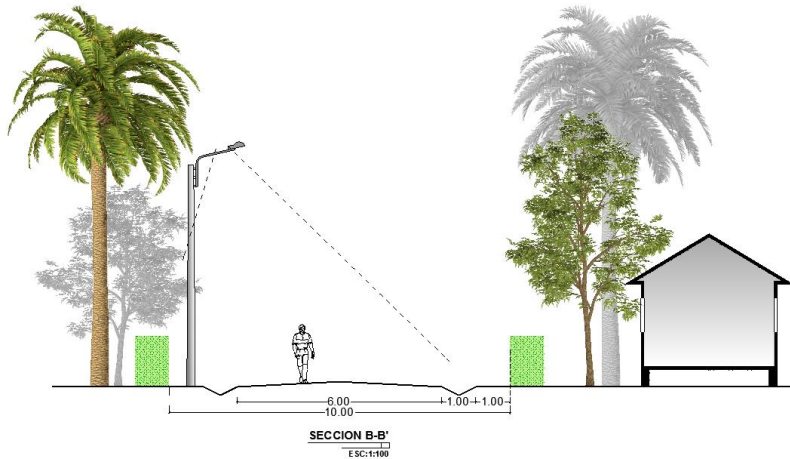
SECCION VIAL DEL BARRIO MIRAFLORES
